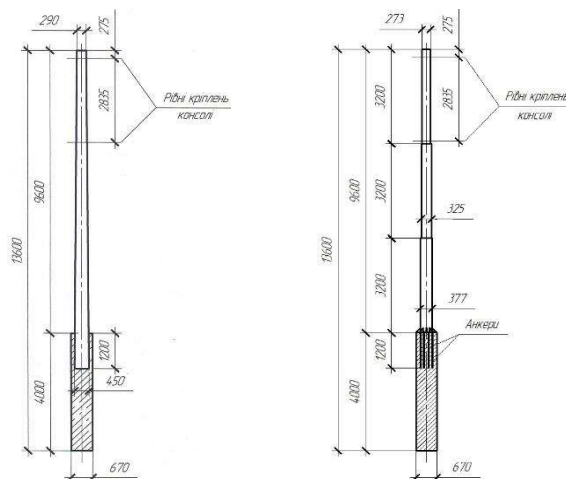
Опори контактної мережі: *а* – типова роздільна залізобетонна із залізобетонним фундаментом стаканного типу; *б* – роздільна металева телескопічна на буронабивному фундаменті з композитною арматурою
